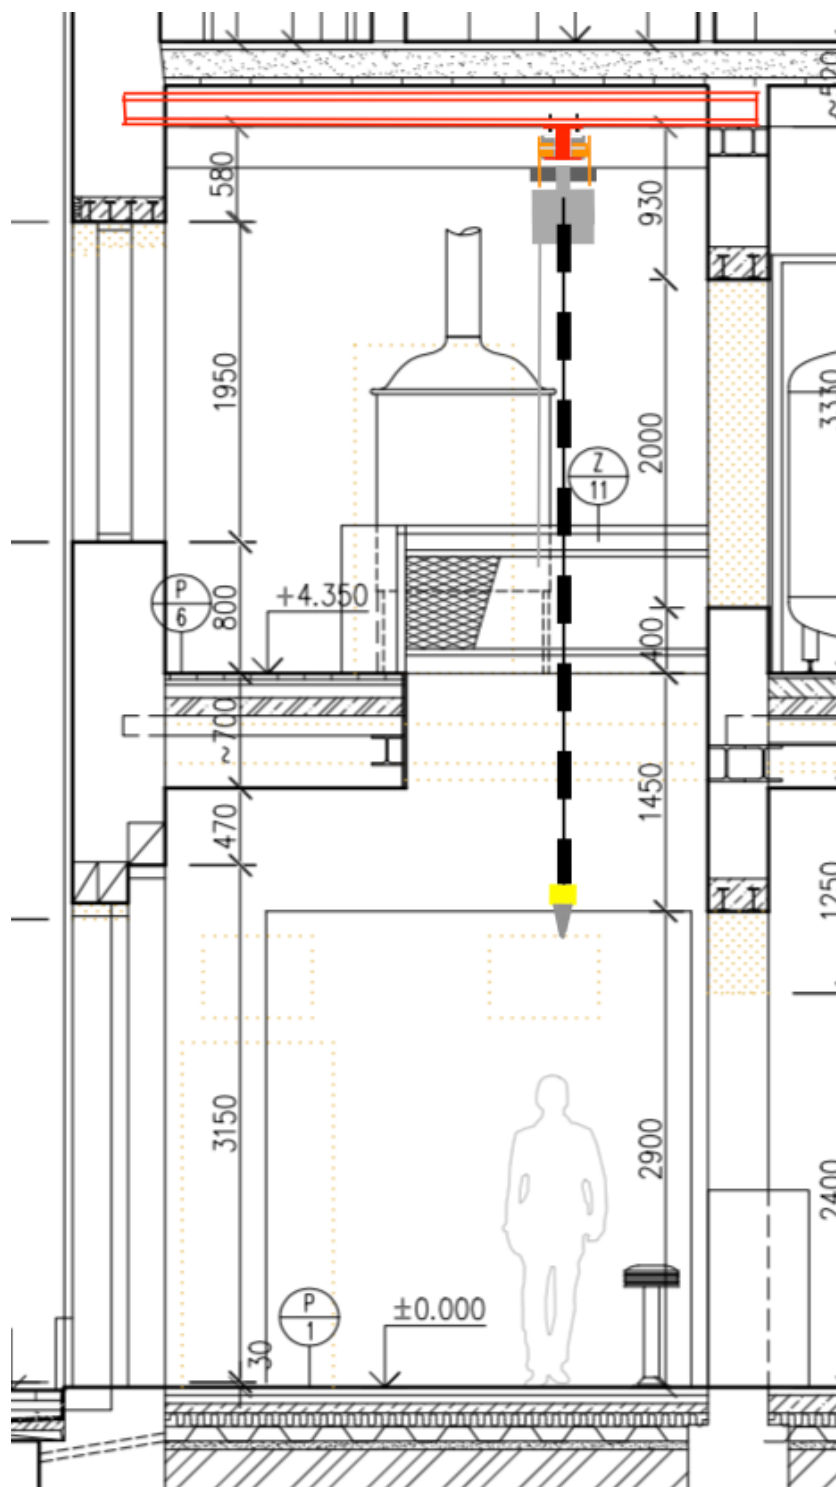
Půdorys; Umístění návrhu B do budovy [Autor]
